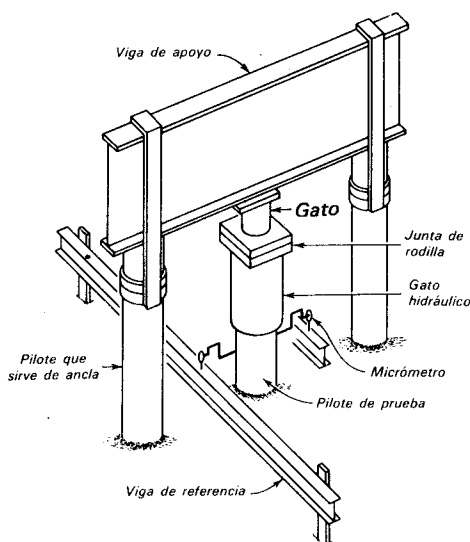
Instalación para hacer una prueba de carga sobre un pilote, usando pilotes de anclaje.
